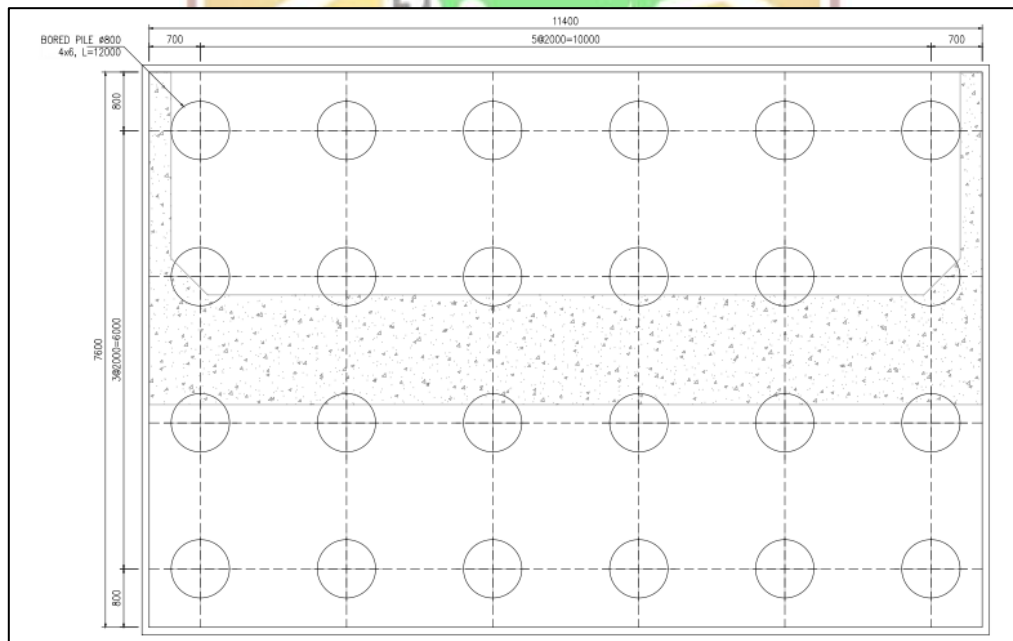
Disain Abutment dan Pile Cap A1
